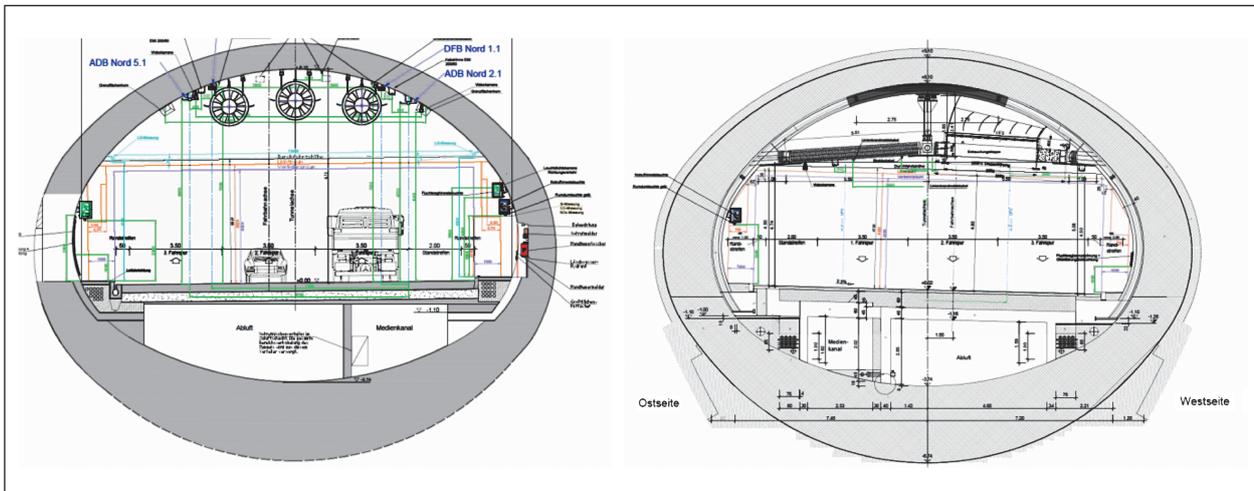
Regelquerschnitte mit betriebstechnischer Ausstattung
